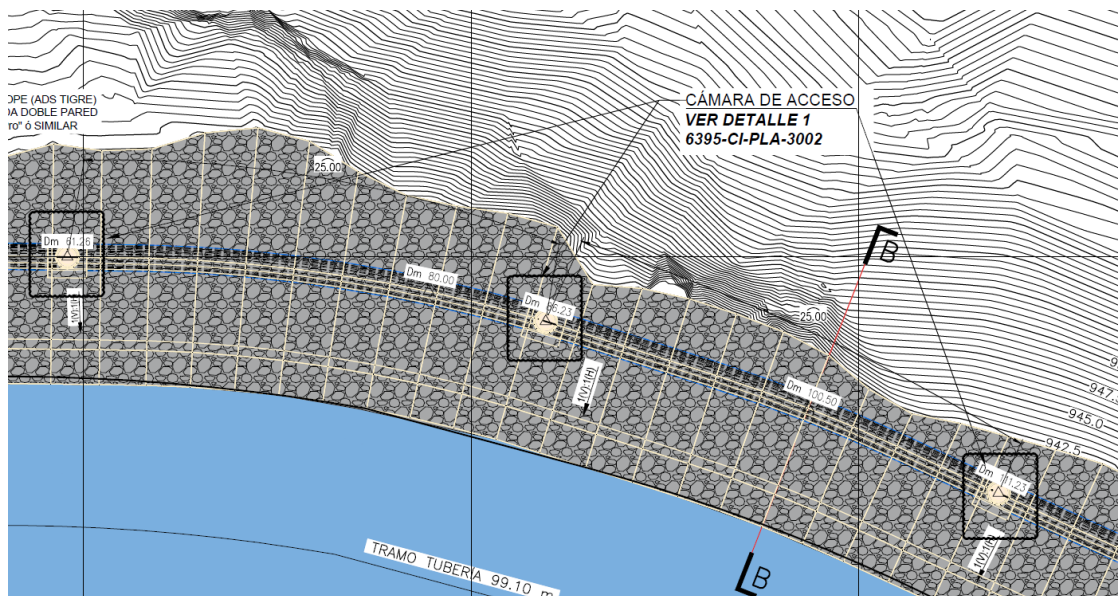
Vista en Planta las cámaras de acceso dispuestas en la tubería
